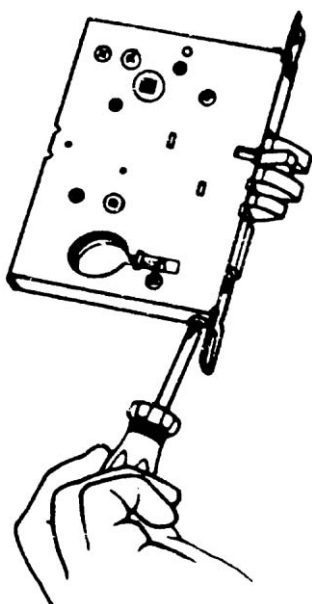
Регулировка положения скошенной защелки с помощью отвертки
